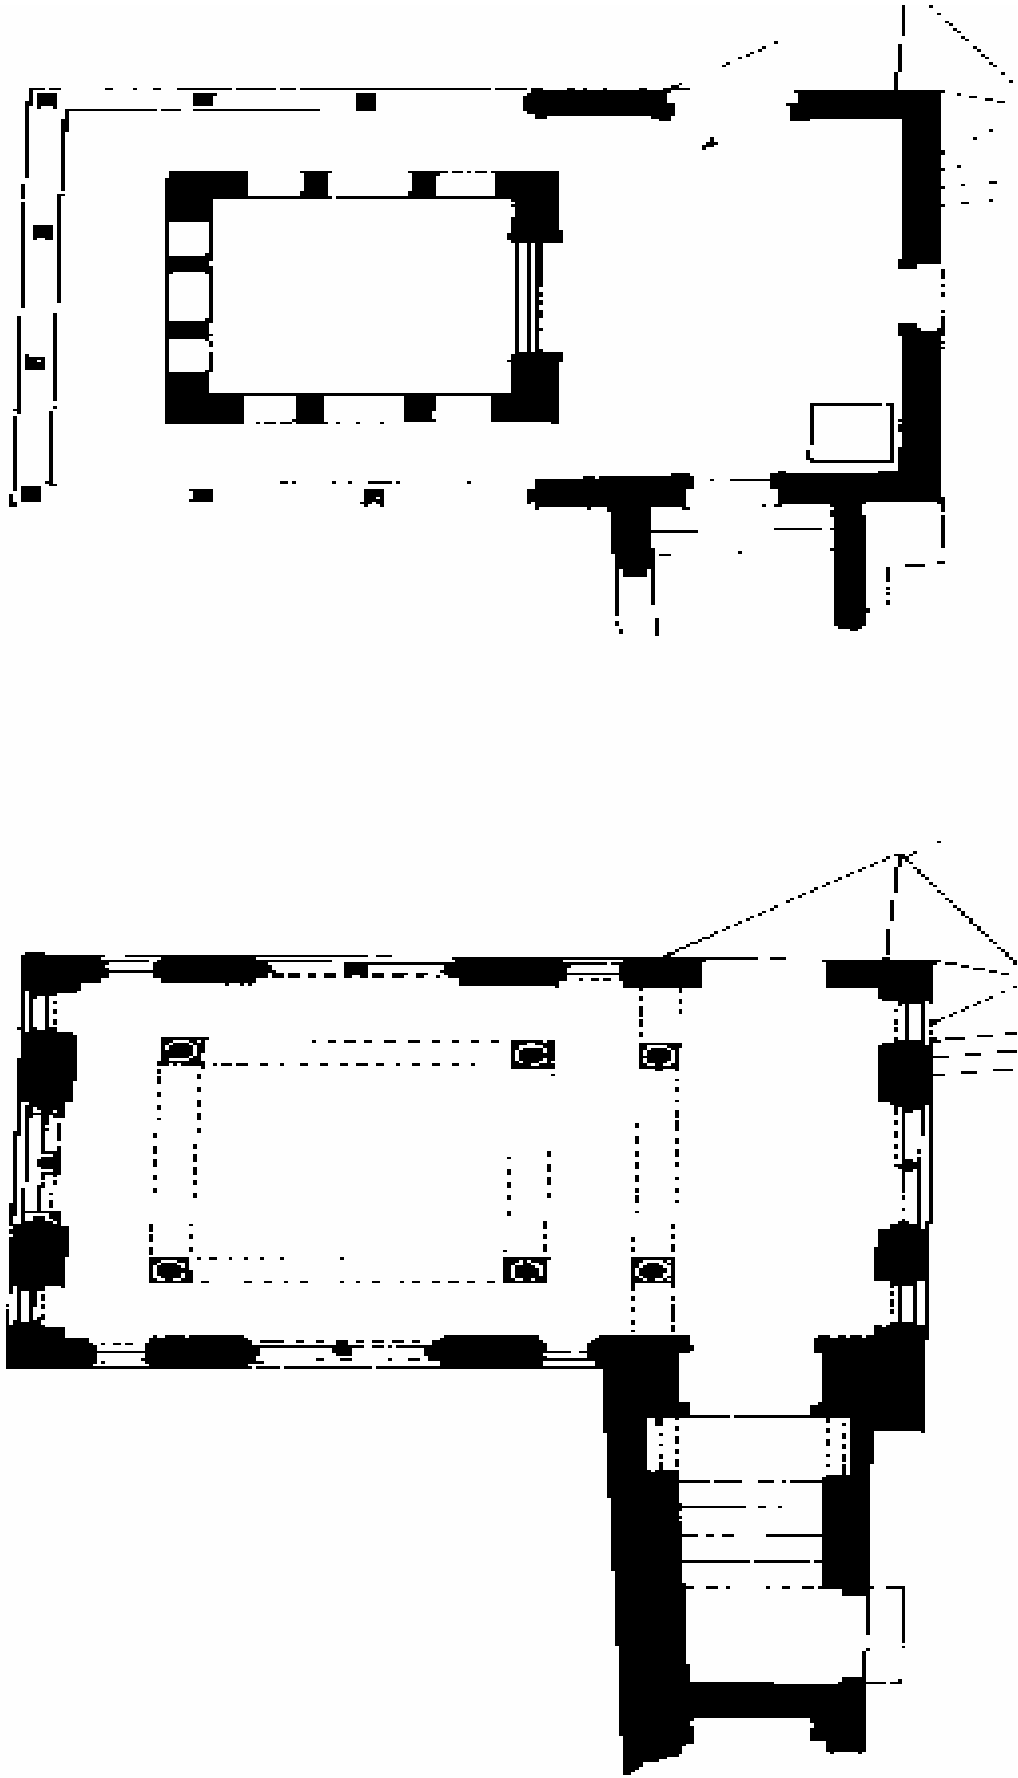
Planta baja (izquierda) y galería de la Torre del Peinador (derecha).
